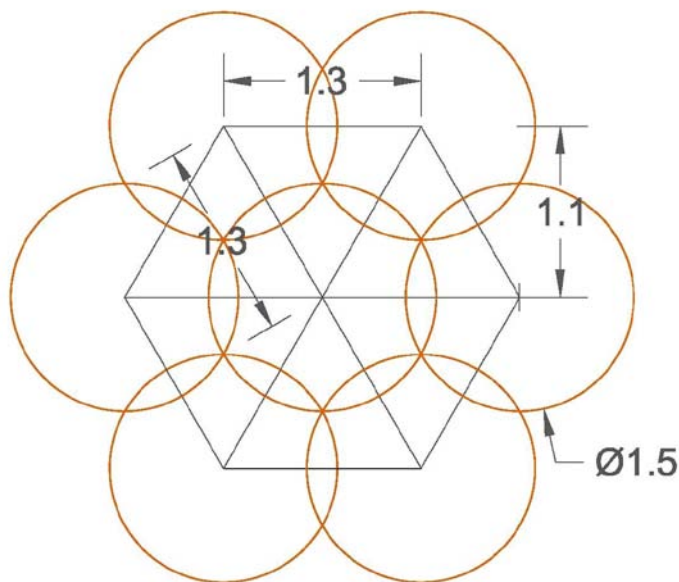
Grundriss Düsenstrahlkörper - Sohle
